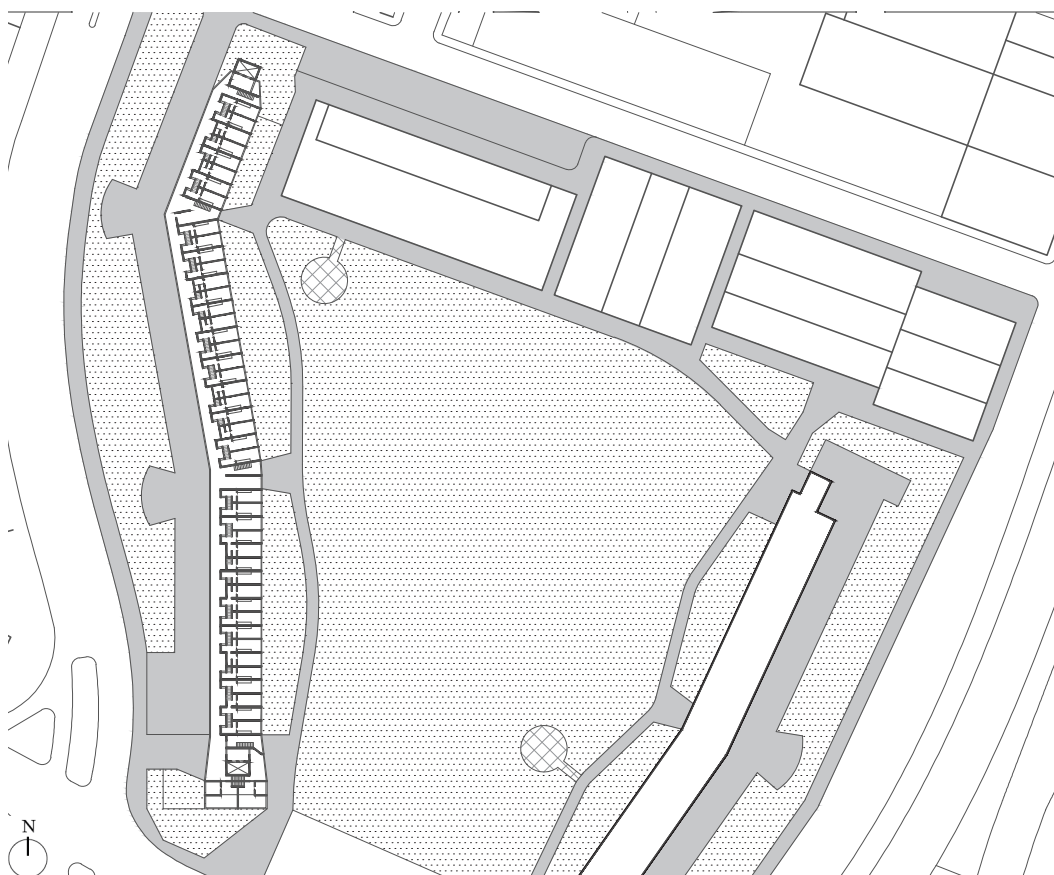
Planta de Pavimentos, Robin Hood Gardens. Escala 1:1500.
